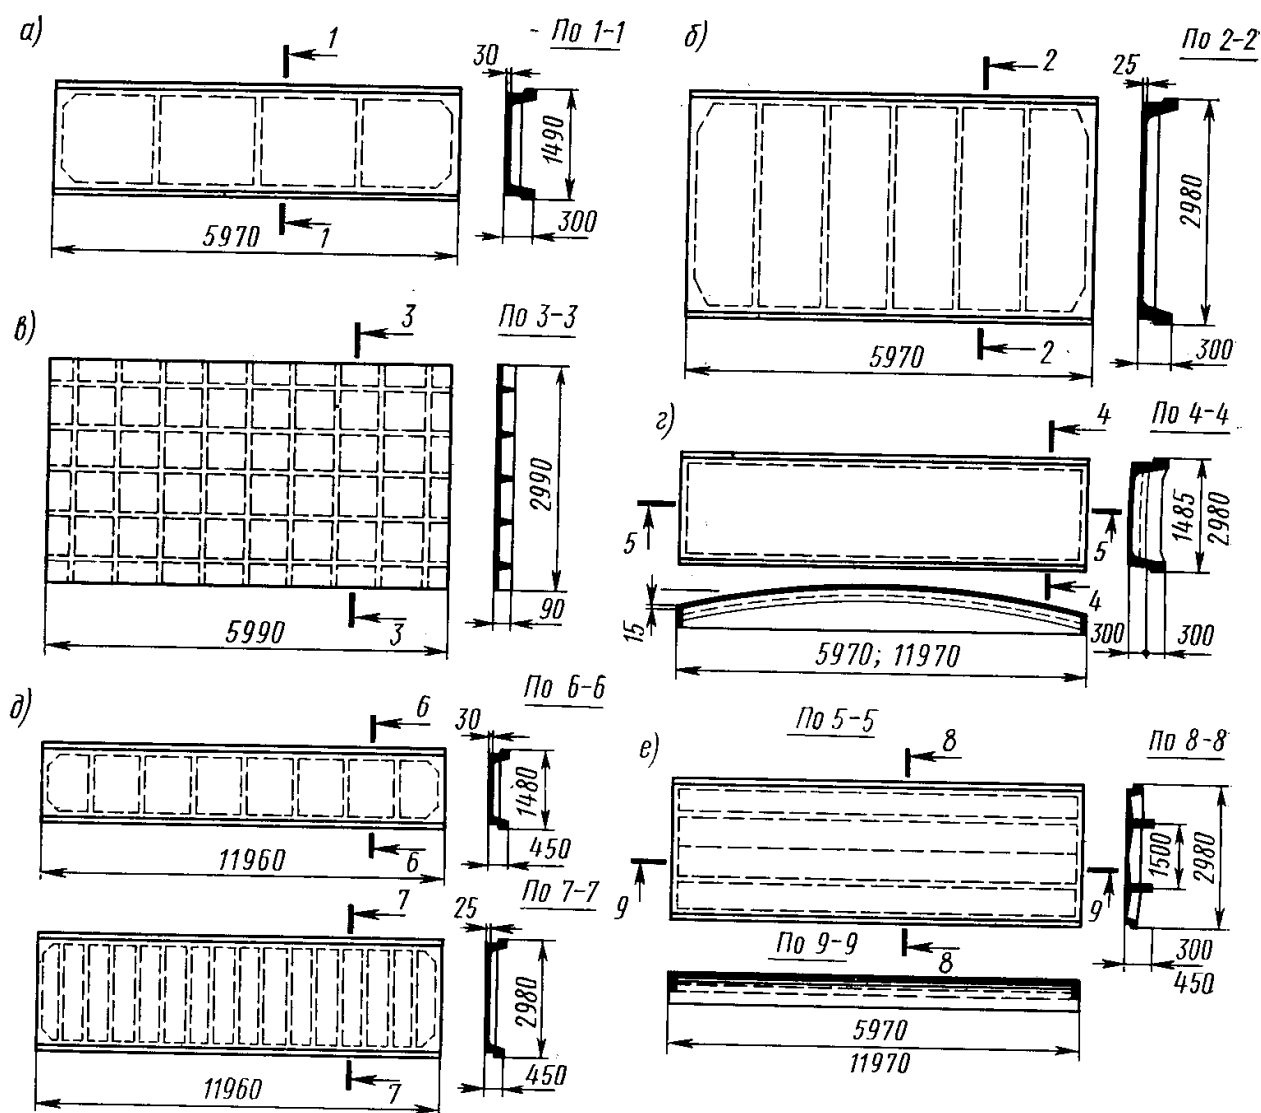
Схеми залізобетонних панелей перекриттів:
